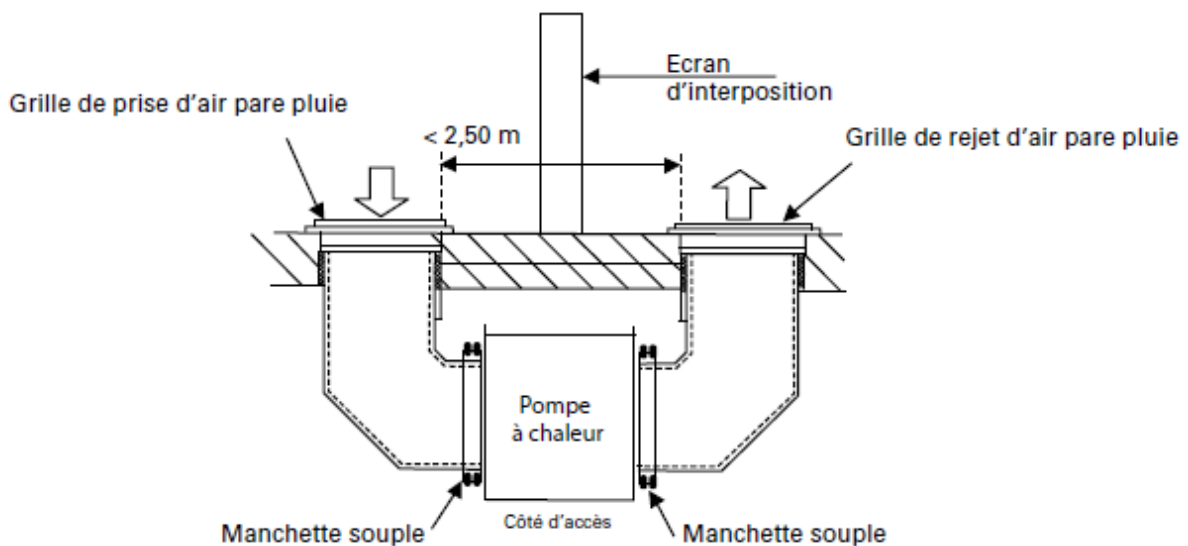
Exemple de disposition des grilles de prise d'air et de rejet d'air sur la même façade avec interposition d'un écran (vue de dessus)
